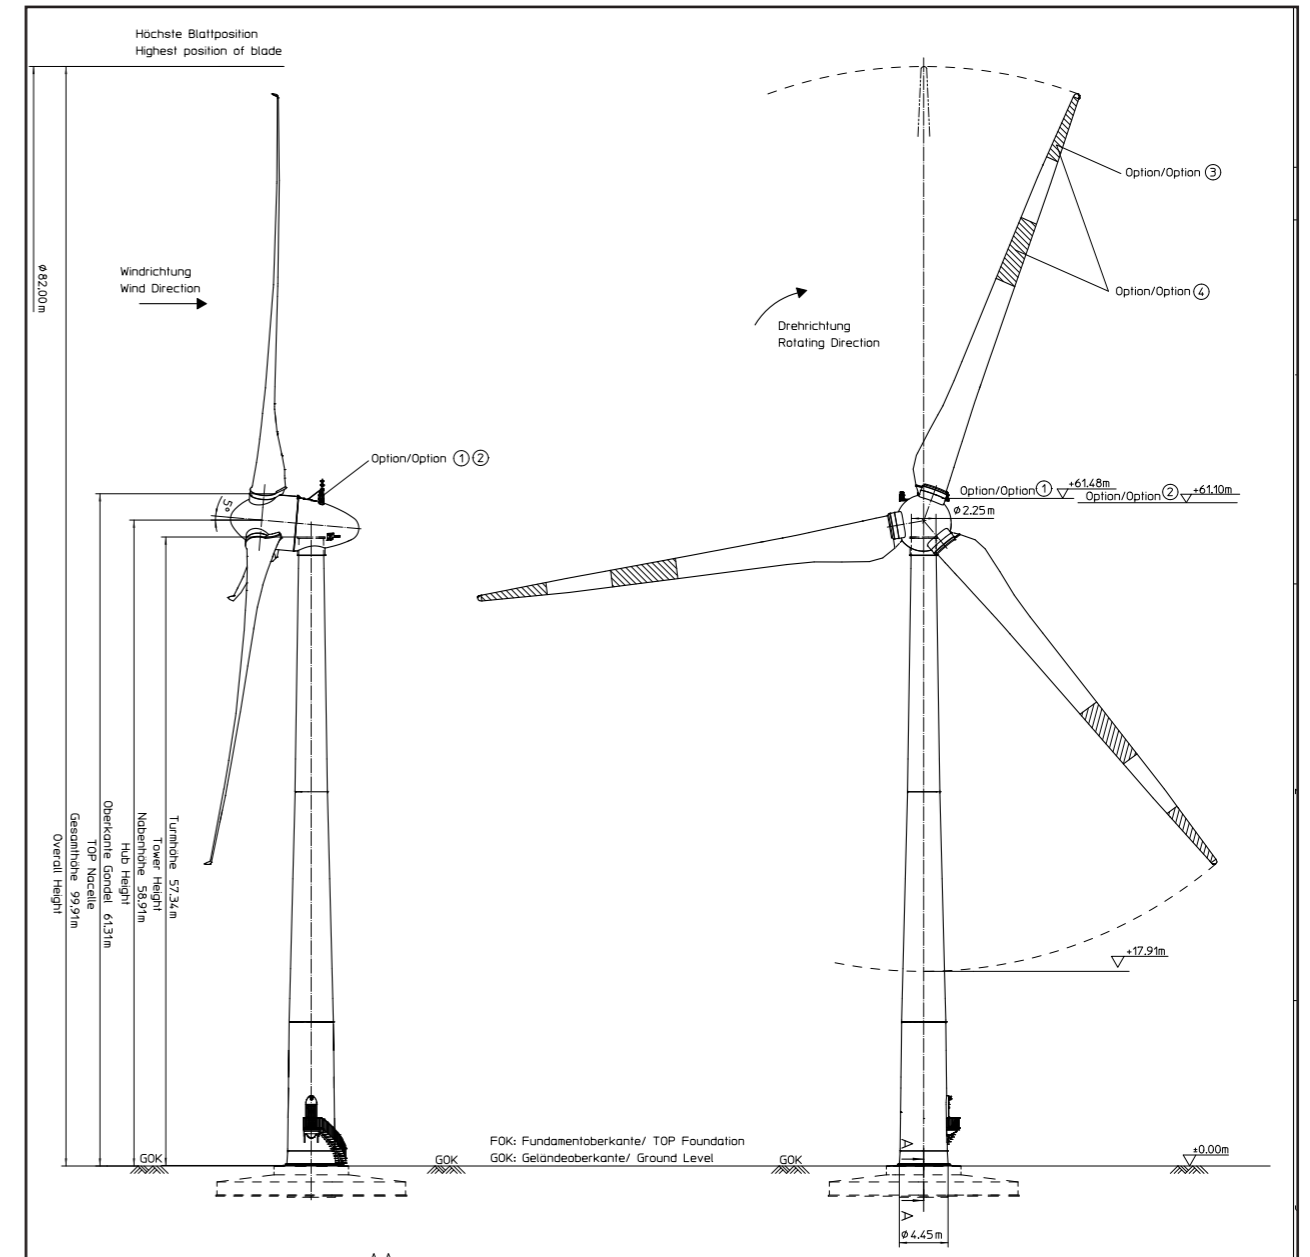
Plan de façade et profil d'une éolienne E-82, hauteur de moyeu de 59 m (EOL 53)
